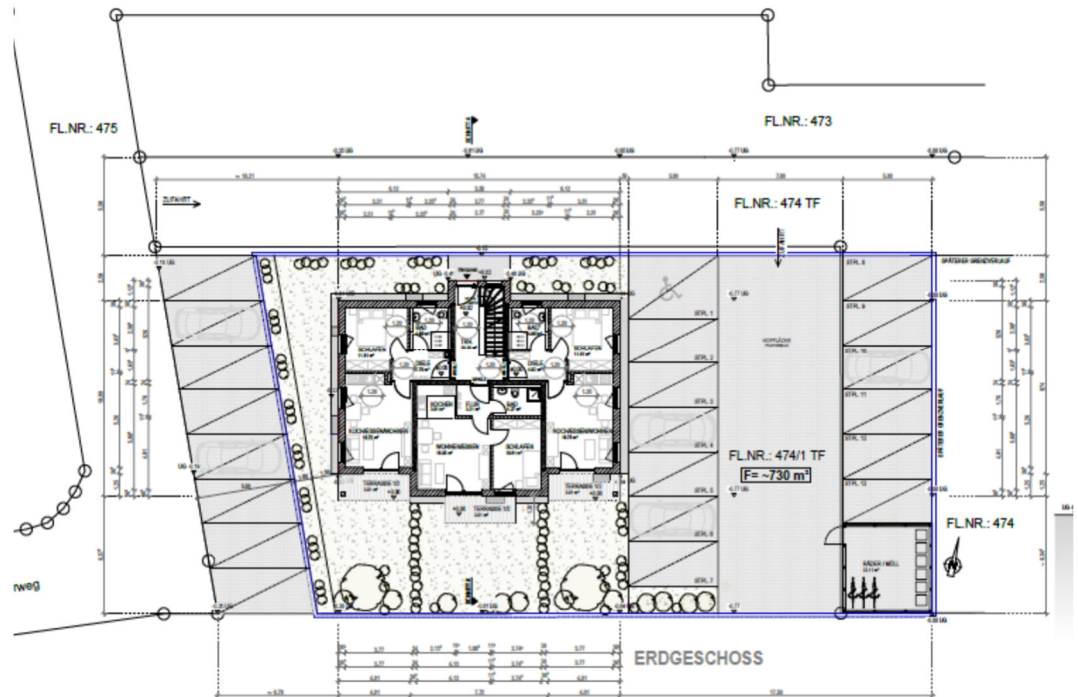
Grundriss Erdgeschoss Mehrfamilienhaus, 14.12.2022, Ingenieurbüro Konrad Huber, Berglern
